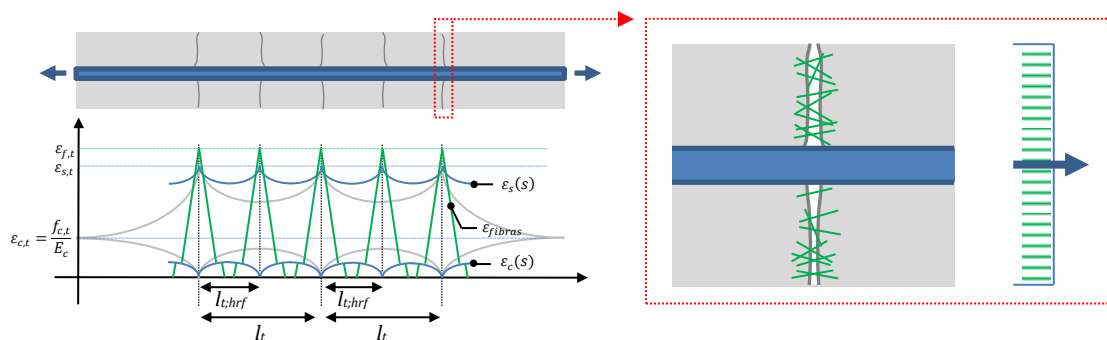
Esquema de las deformaciones en el hormigón, armadura convencional y fibras para fase final de la fisuración del HRF
